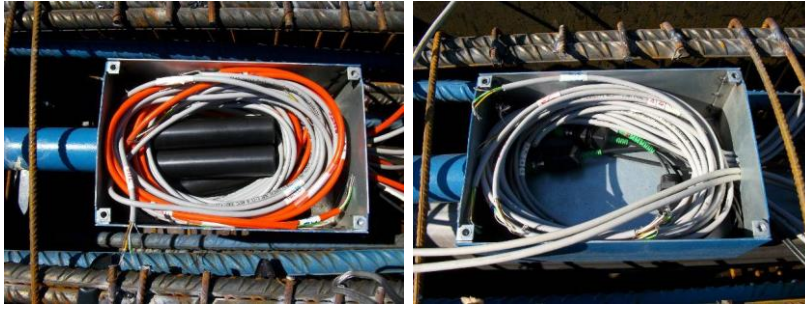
Izda.) Cableado alojado en cajetín de junta inferior. Dcha.) Cableado alojado en cajetín de junta superior
